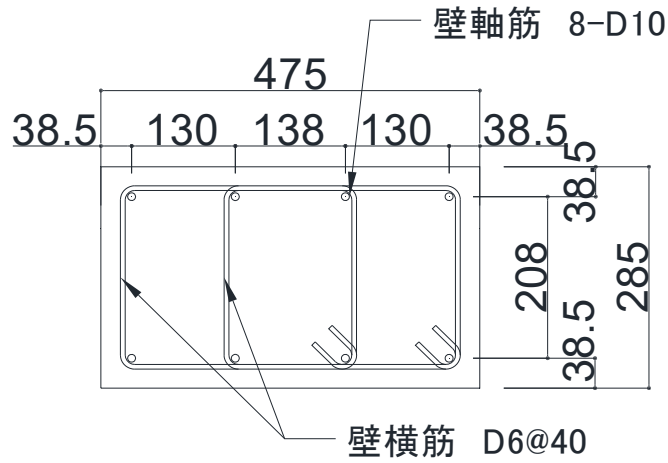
RC 壁部分 断面図 (単位: mm)
